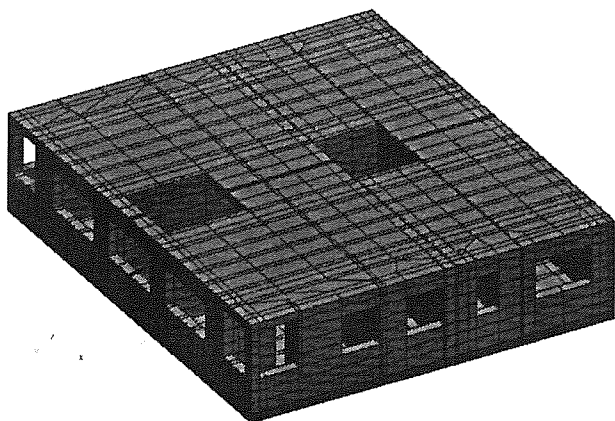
Planta de un edificio de viviendas. Discretización en elementos finitos.
